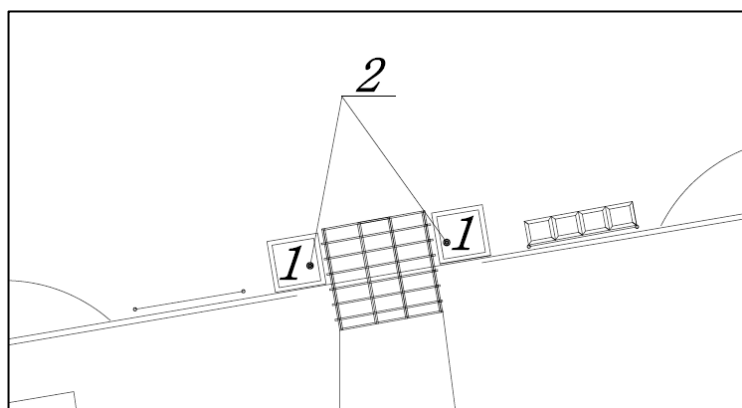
Фрагмент генплана 3, схема посадки растений для входной зоны
